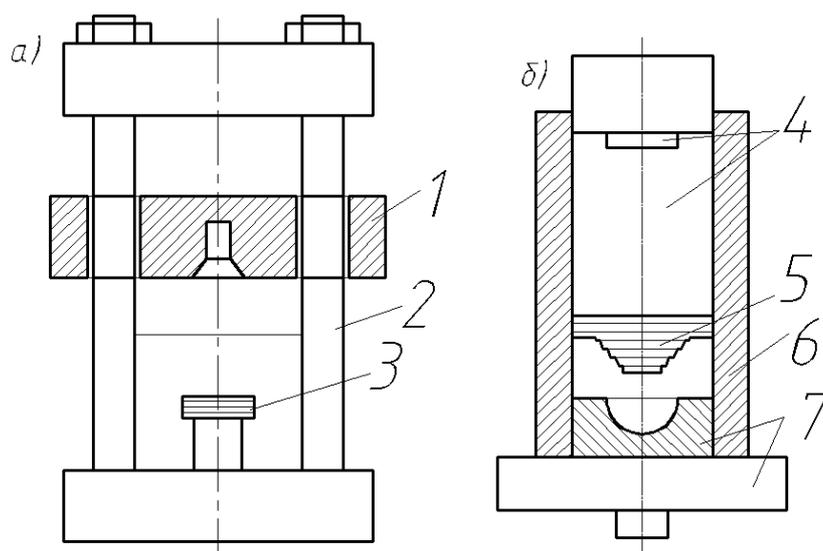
Принципиальные схемы дизель-молотов (штангового (а) и трубчатого (б)): 1-подвижный цилиндр; 2-направляющие штанги; 3-поршень; 4-подвижный поршень; 5-головка; 6-неподвижный цилиндр; 7-шабот.
